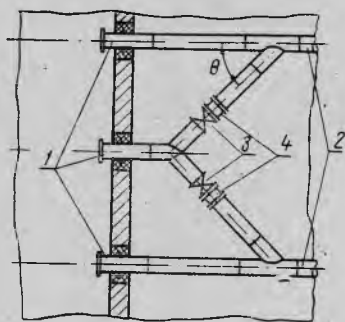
Схема соединения трех трубопроводов 1, идущих от насосов с двумя напорными трубопроводами 2; 3 — переключающие задвижки; 4 — монтажные вставки.
